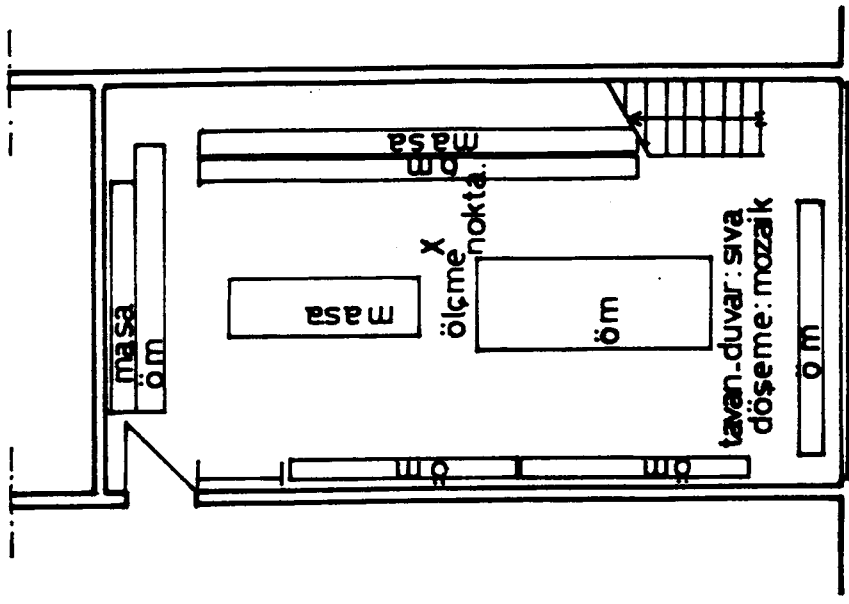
14 No'lu Atelyeden bir görünüş
